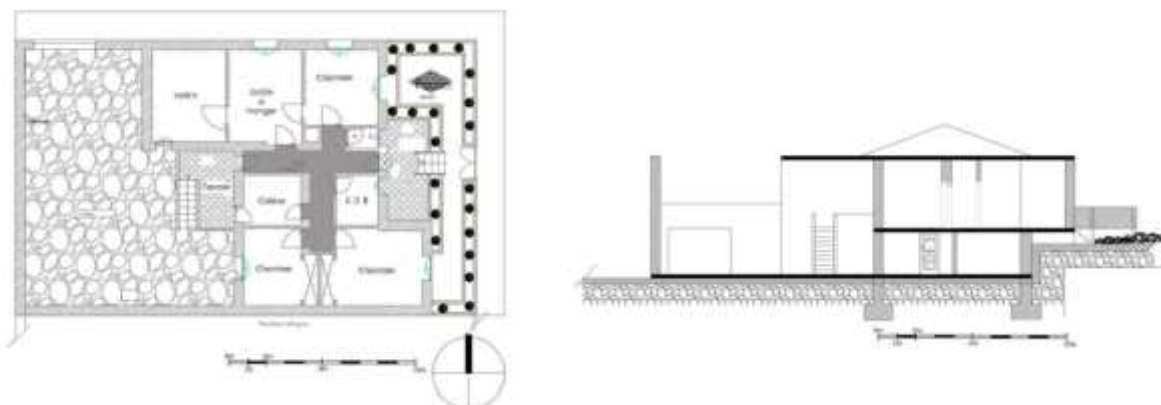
Cité Lévy. Plan et coupe d'un pavillon d'angle. Source/ Dessin de l'auteur
